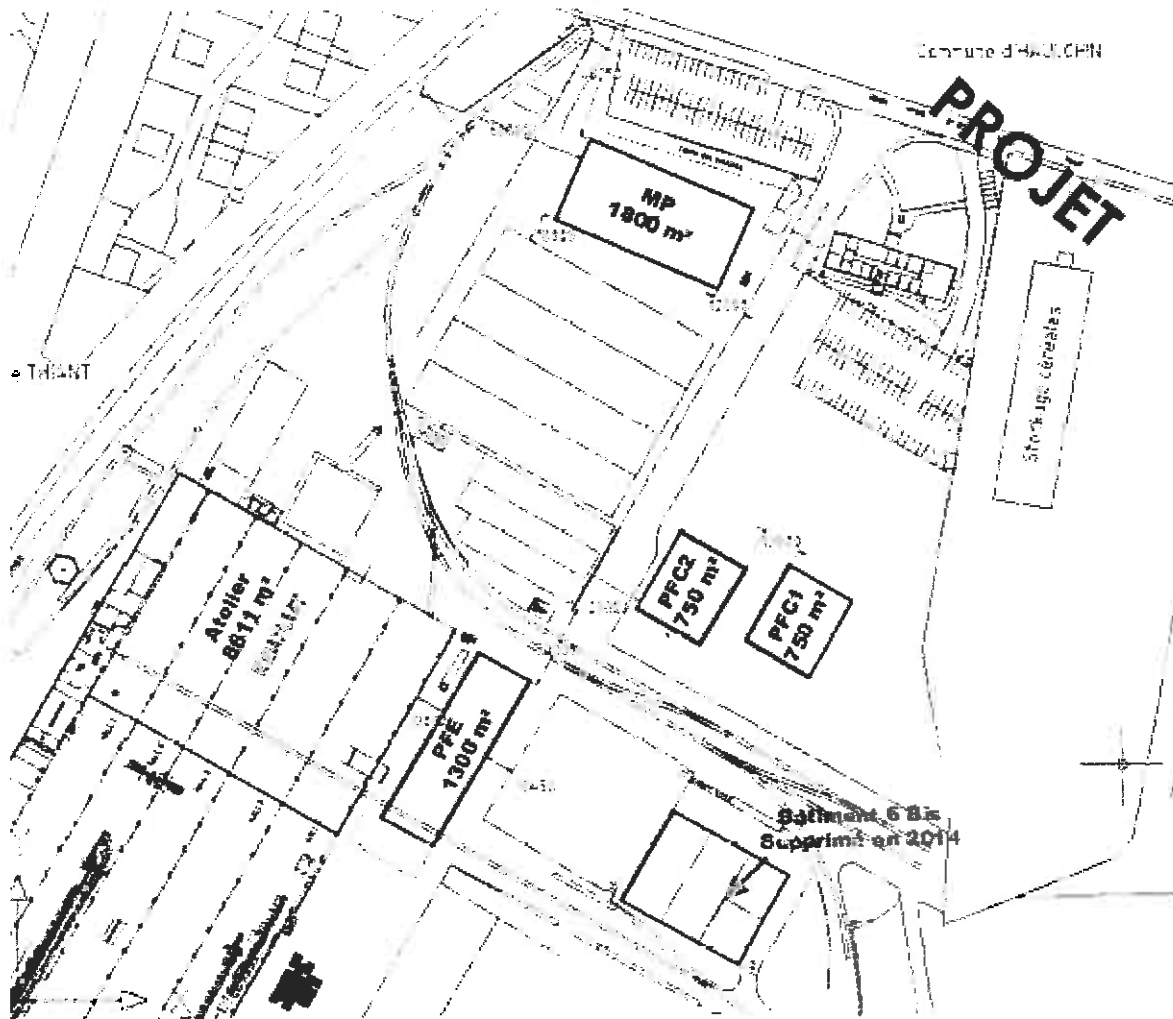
Plan d'implantation du bâtiment de 1300 m<sup>2</sup> en projet
